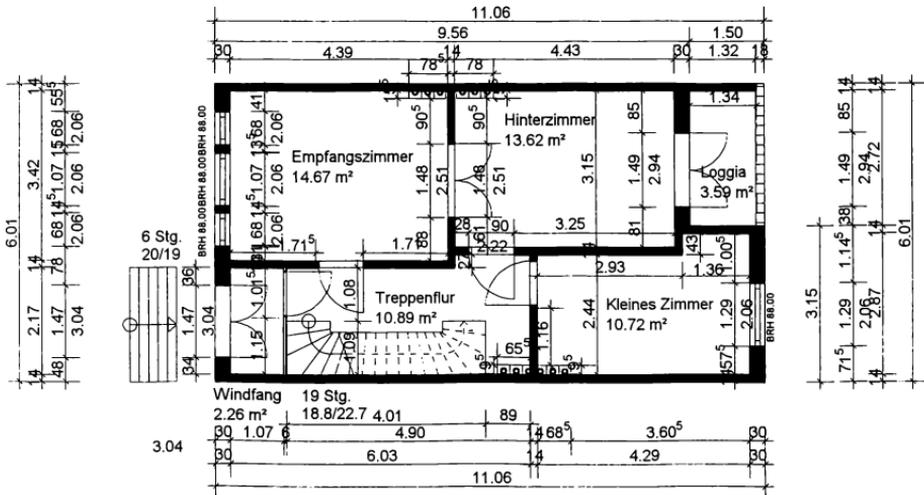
Grundriss Hochparterre Bückeburger Str. 16
